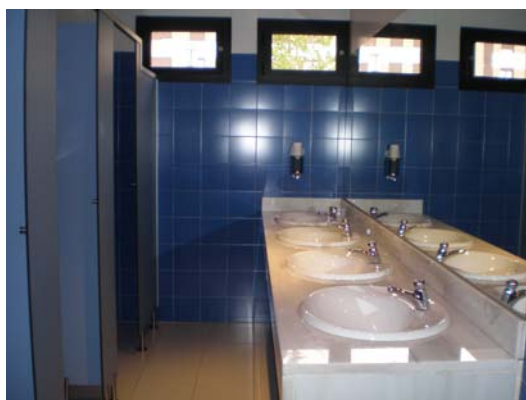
Baño señoras primera Planta. Edificio 17.
